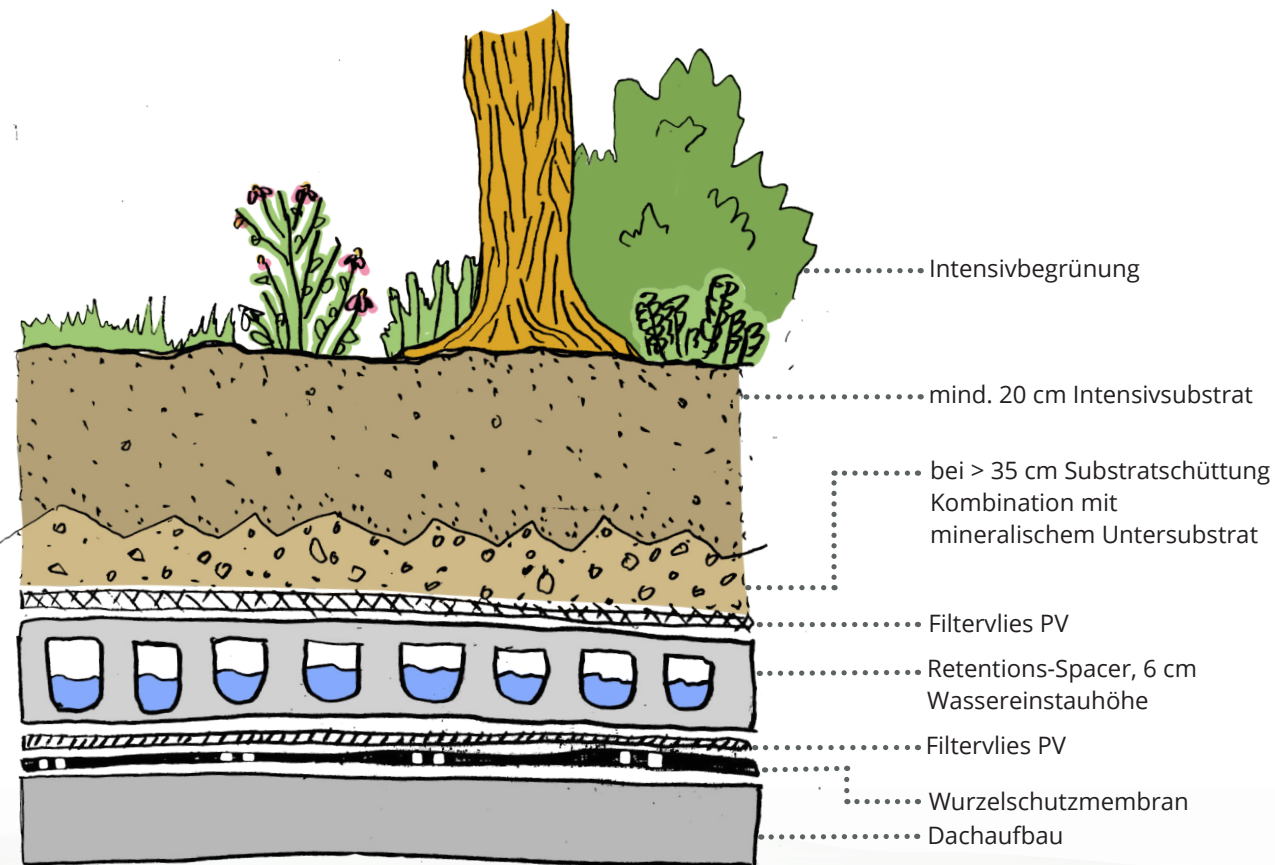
Systemaufbau Retentionsgründach intensive Dachbegrünung mit 6cm hohen Retentionsabstandshalter (TUD 2025 nach ZinCo 2023 b: 9).
